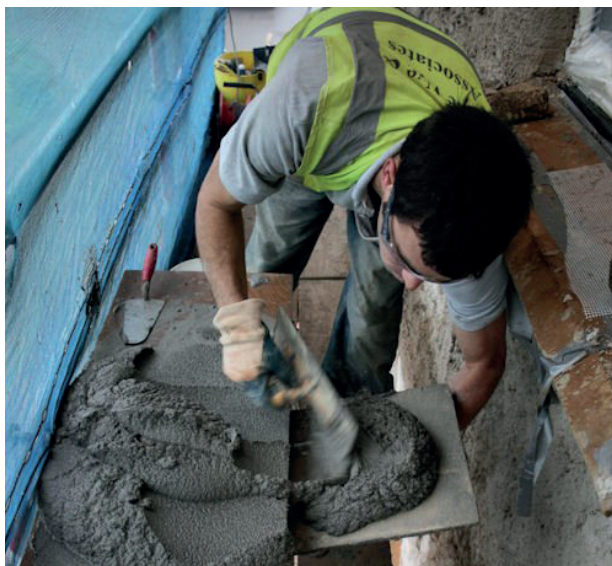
• Aplicação de argamassas térmica para pavimentos
